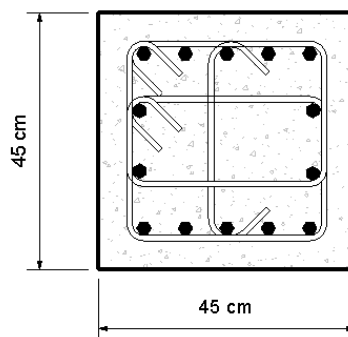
Sección transversal columna. Fuente: elaboración propia.
